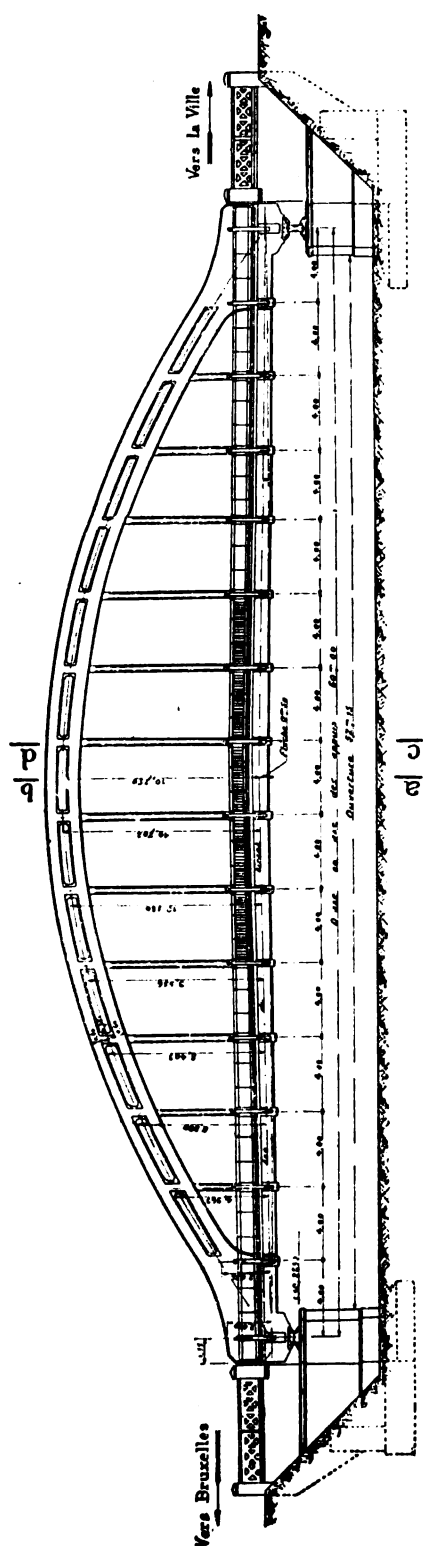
Cavalcavia della Stazione di Thermonde.
